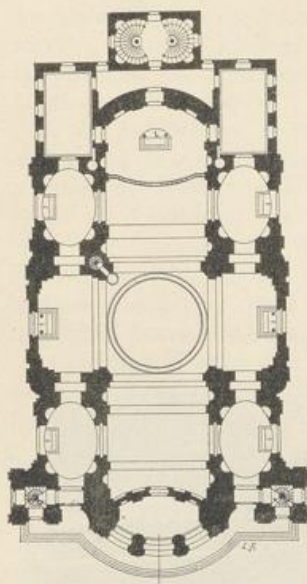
Grundriss der Kollegienkirche zu Salzburg
